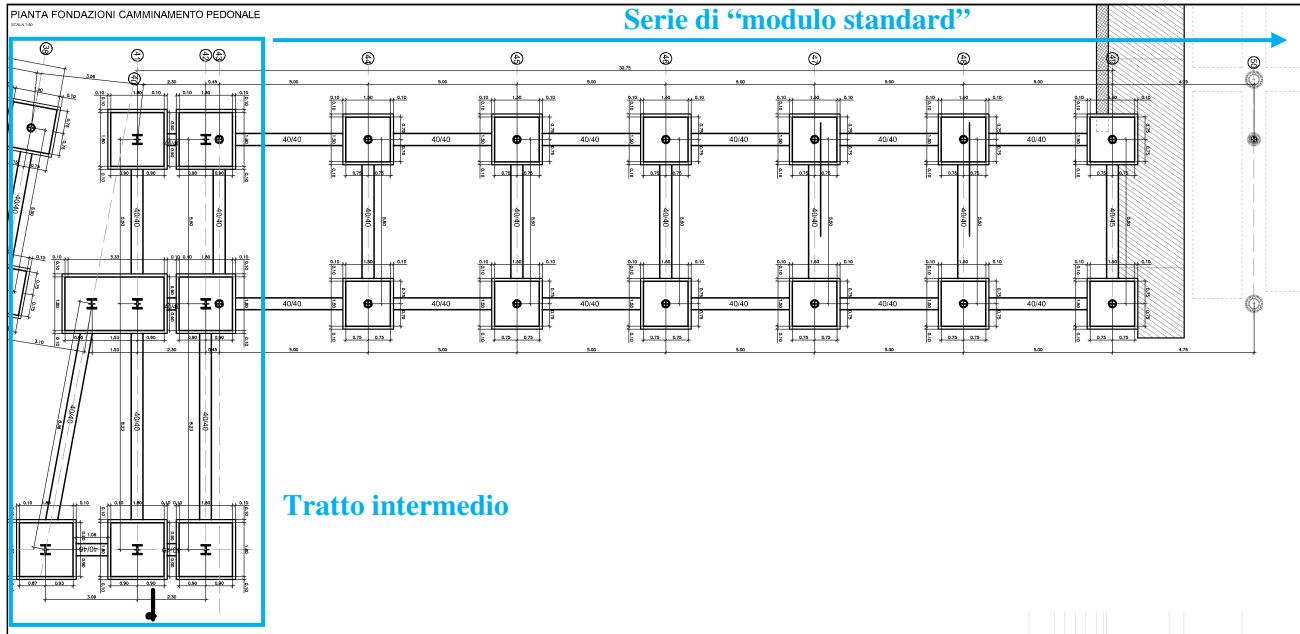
Estratto pianta delle fondazioni del Camminamento pedonale
